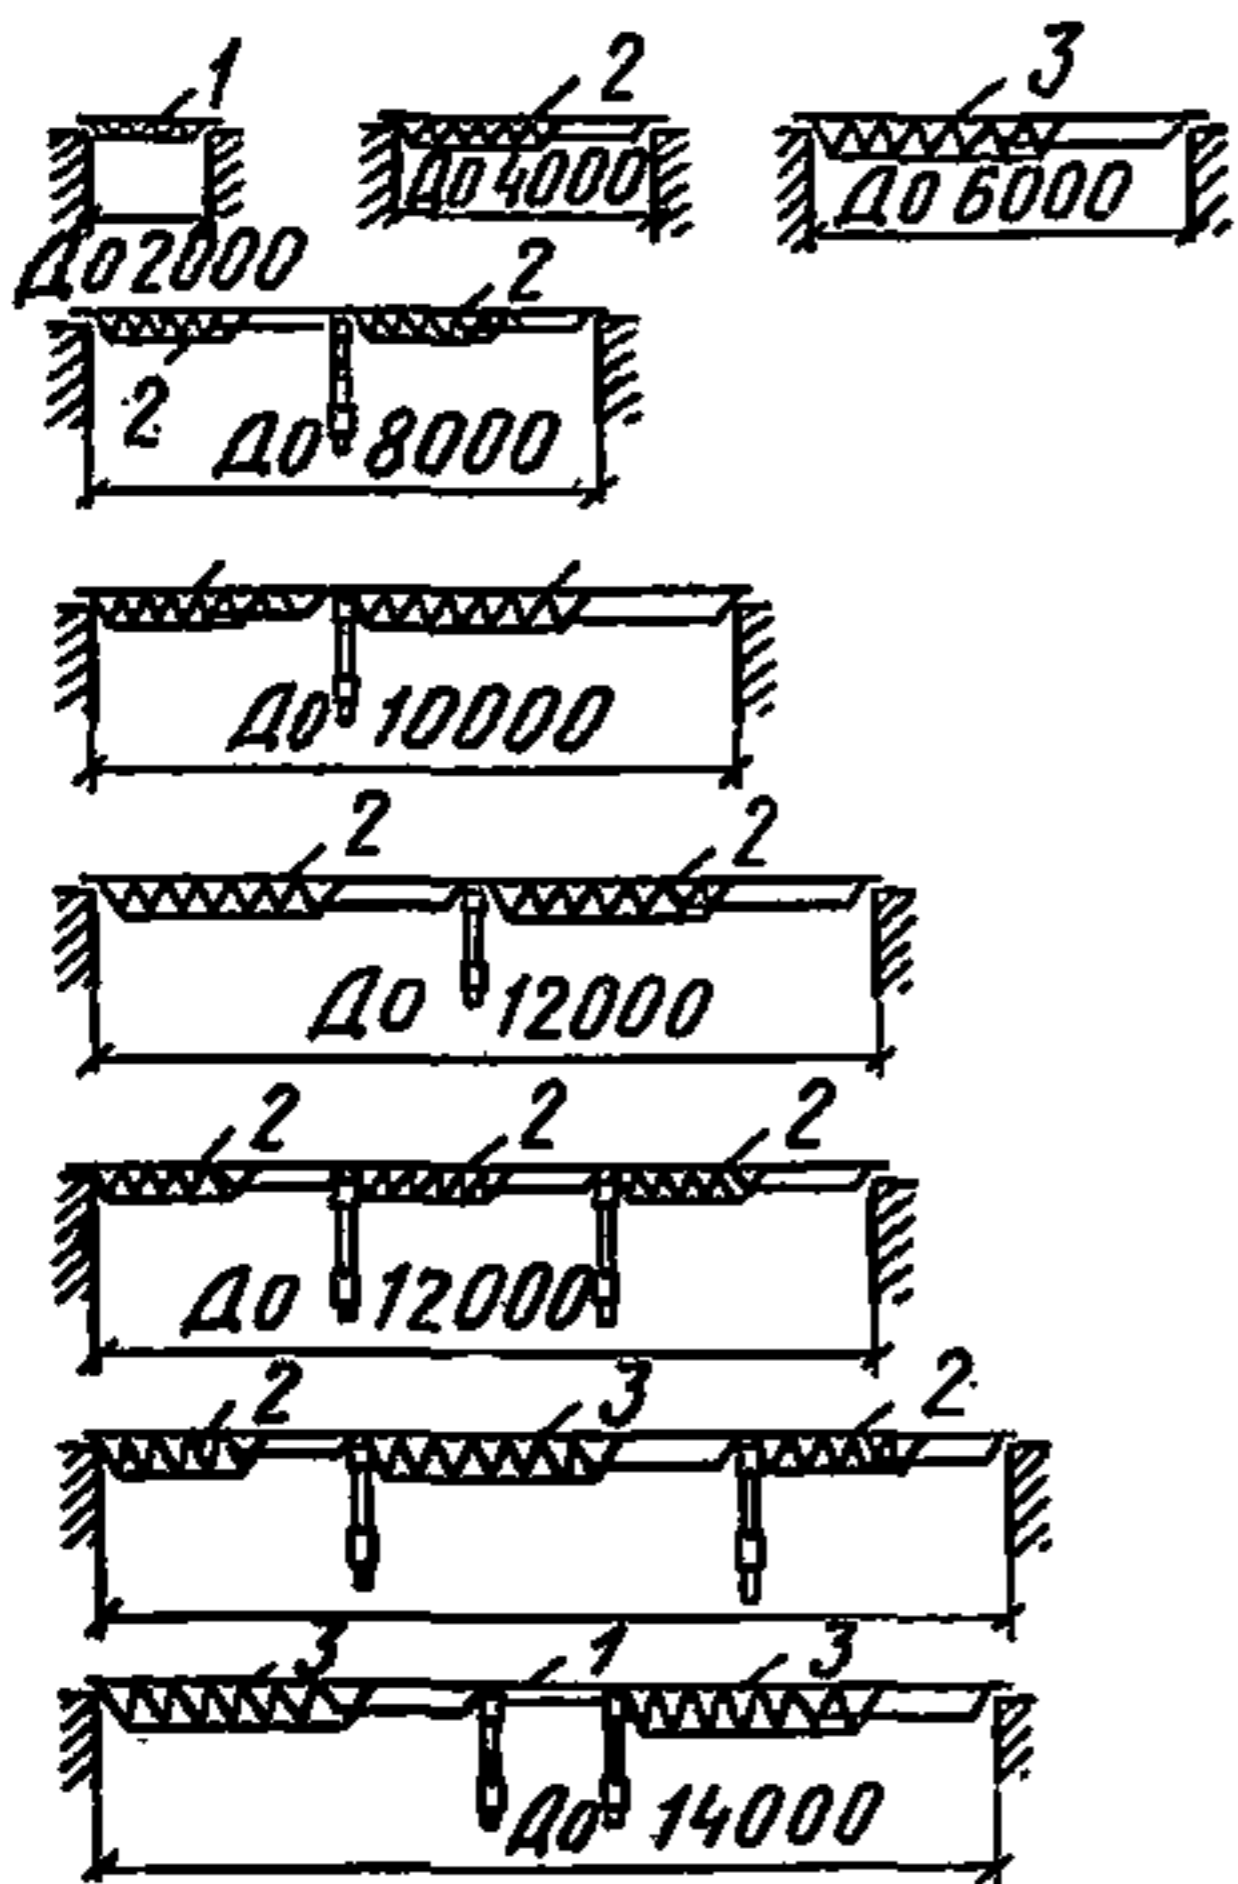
Схема установки передвижных ригелей конструкции ЦНИИ-ОМТП для опирания опалубки плит перекрытия различных пролетов
